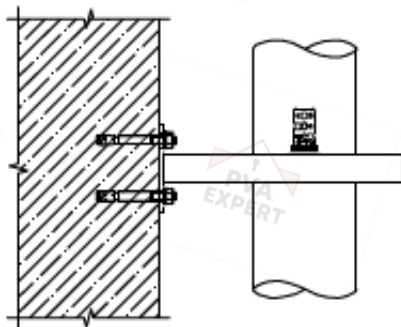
Узел крепления вертикального круглого воздуховода к стене
